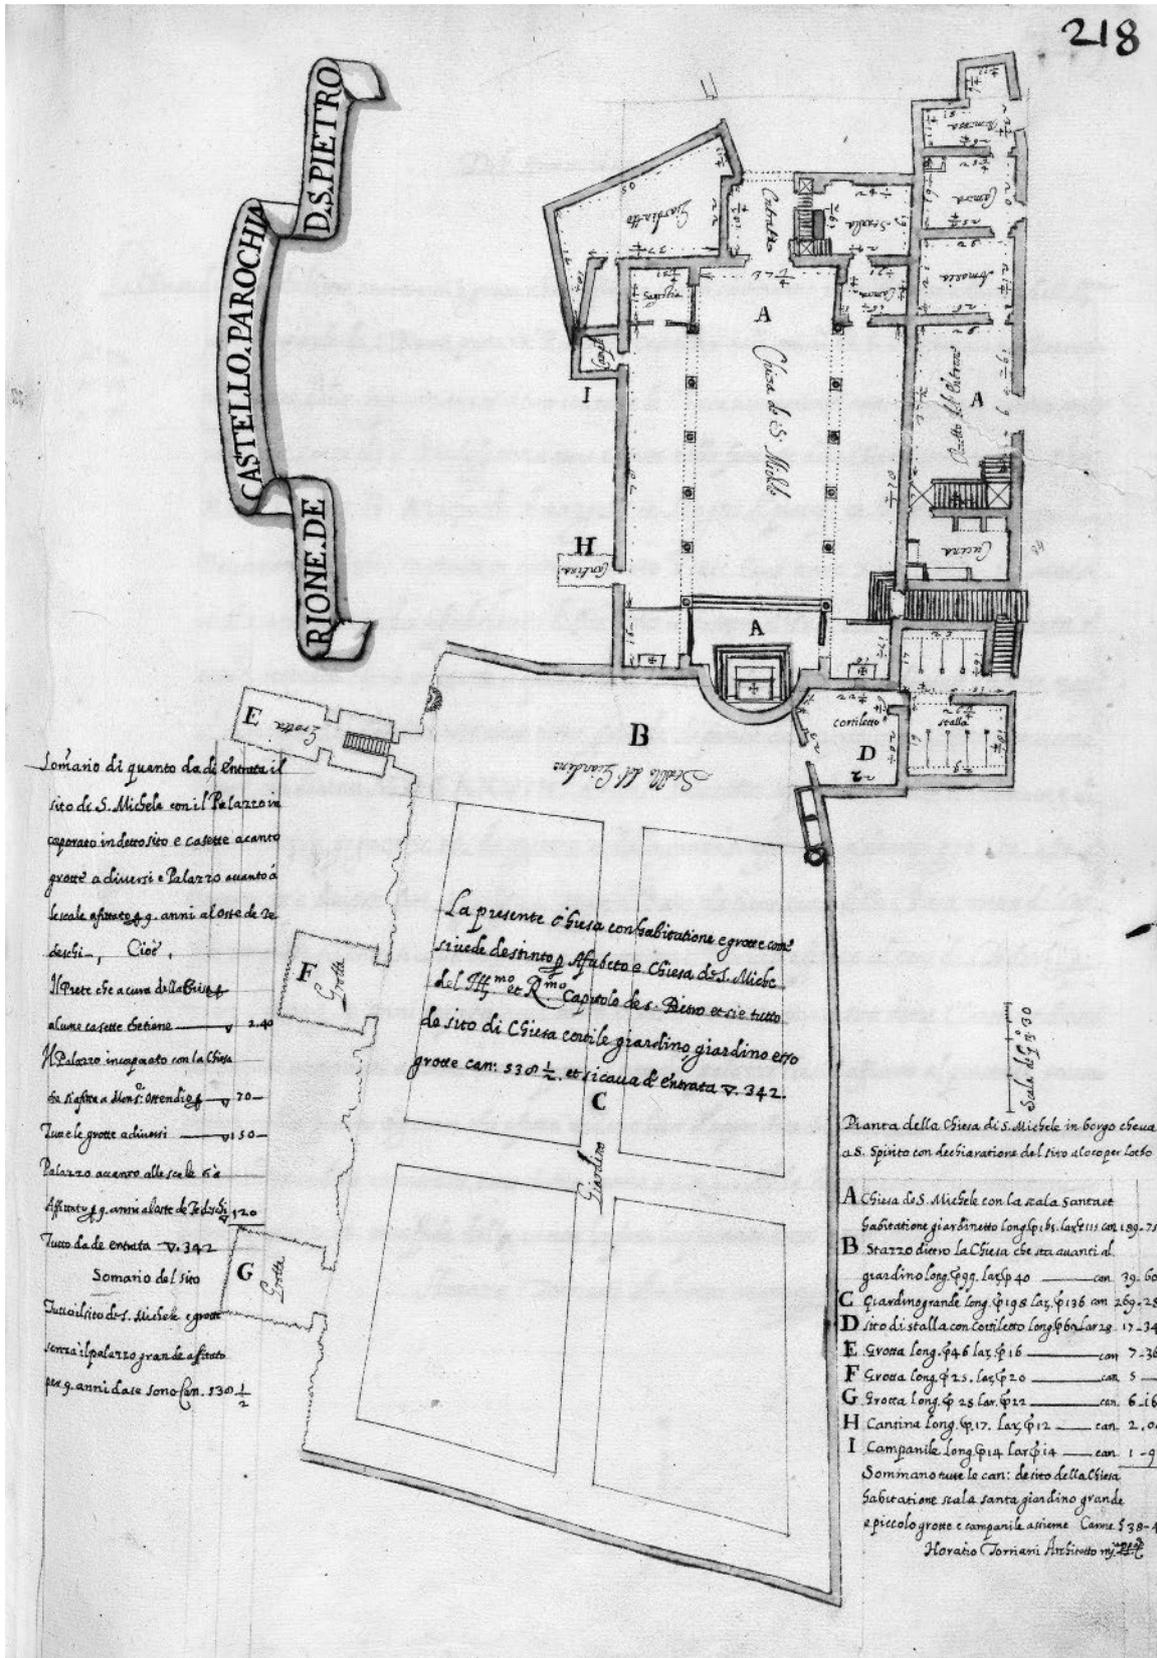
Rom, SS. Michele e Magno, Prospero de Rocchi, Grundriss mit umgebenden Gebäuden und Gärten, 1600. BAV, ACSP Catasti e piante 10, fol. 218 (Foto Archivio Capitolo S. Pietro)
